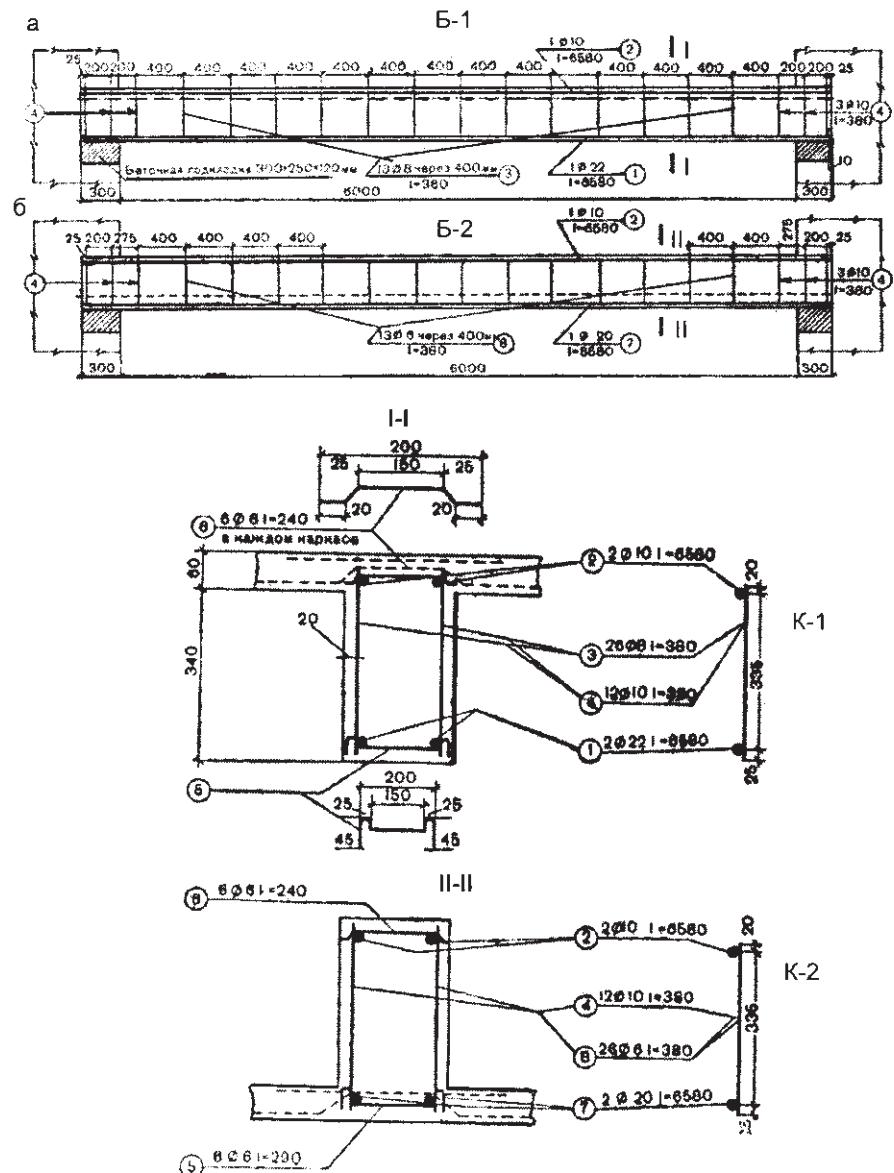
Разрез сварных каркасов двух балок по длине
